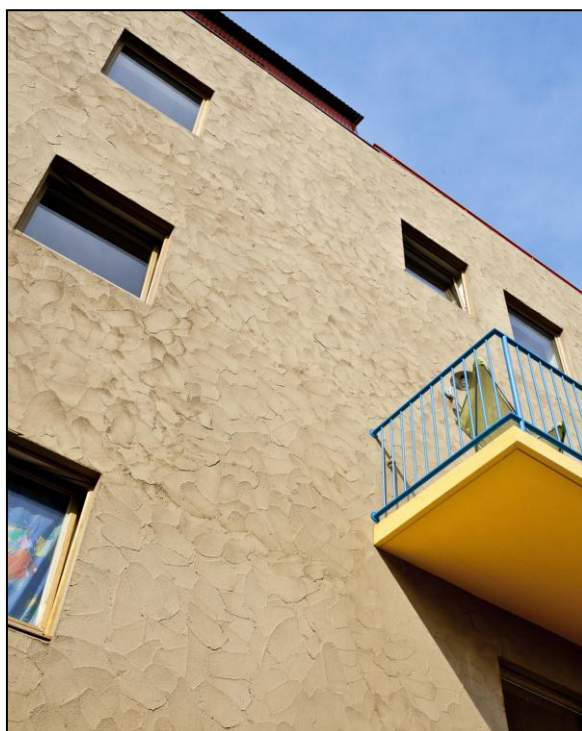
Façade sud de l'immeuble Babel Ouest, enduite à la main
